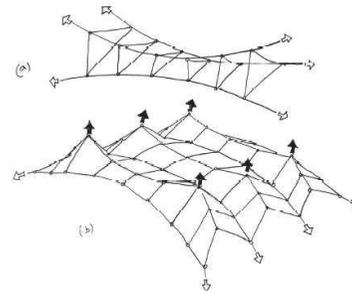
Estructuras tensadas por cables (a) y estructuras tensadas por puntos (b).
